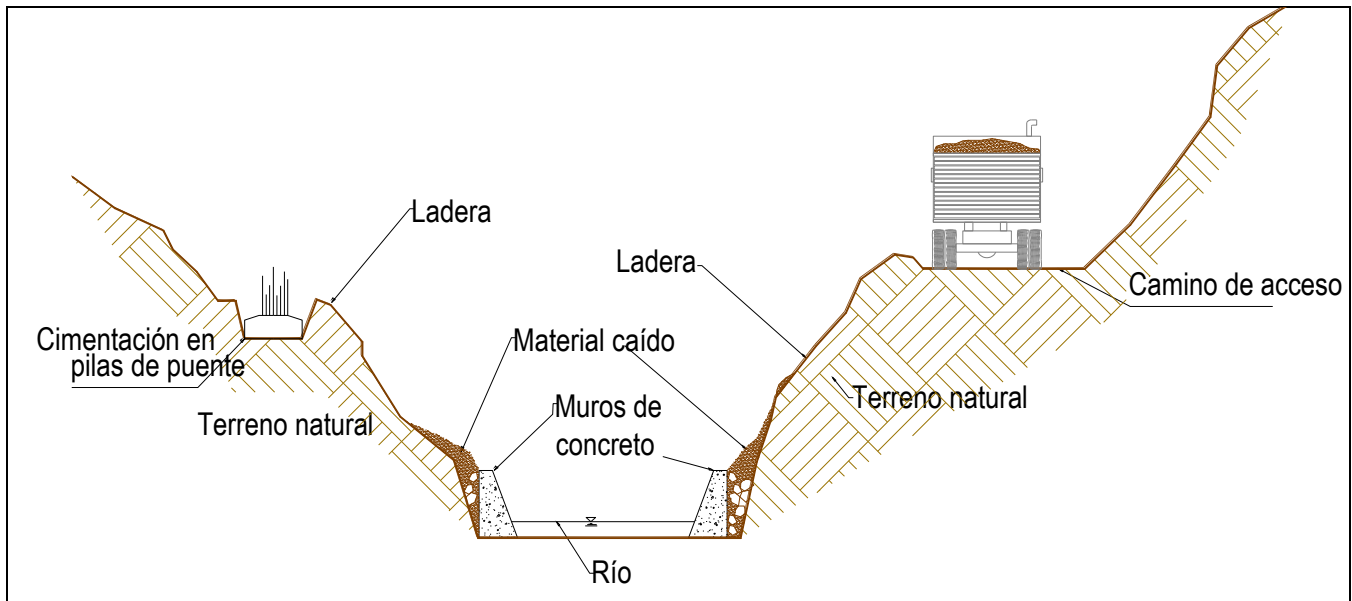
Esquema tipo de la colocación de una barrera de concreto en los márgenes de un río.
